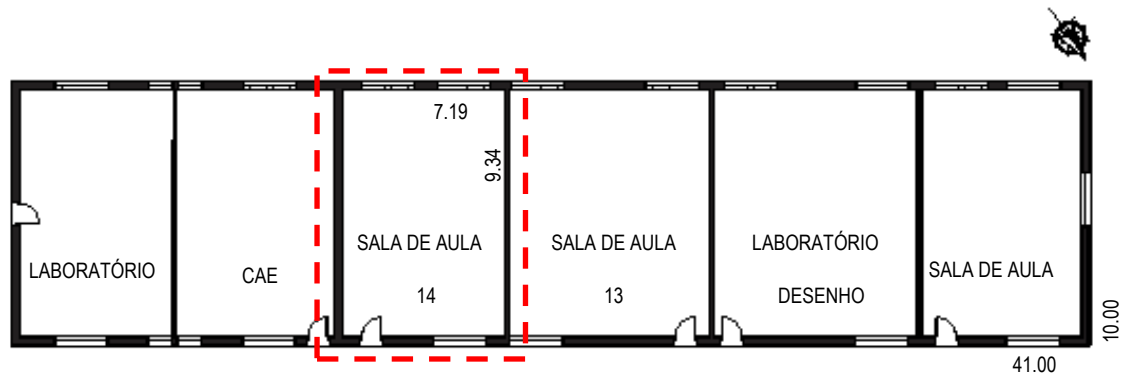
Planta Baixa do Prédio 63 com a indicação da sala de aula usada como referência para a área de ventilação.
